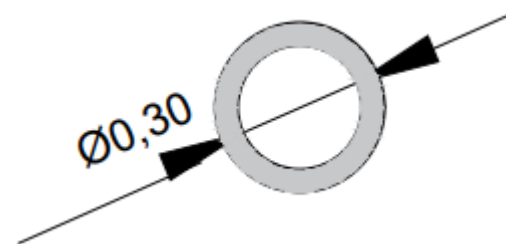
Sección dren longitudinal cimentación. Fuente: Elaboración propia.
